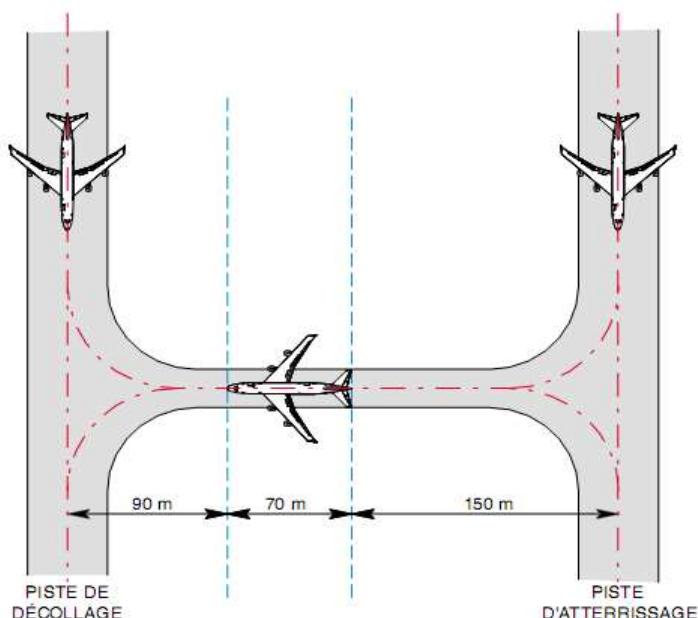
Calcul de la distance minimale entre 2 pistes parallèles avec un avion de longueur 70 mètres
